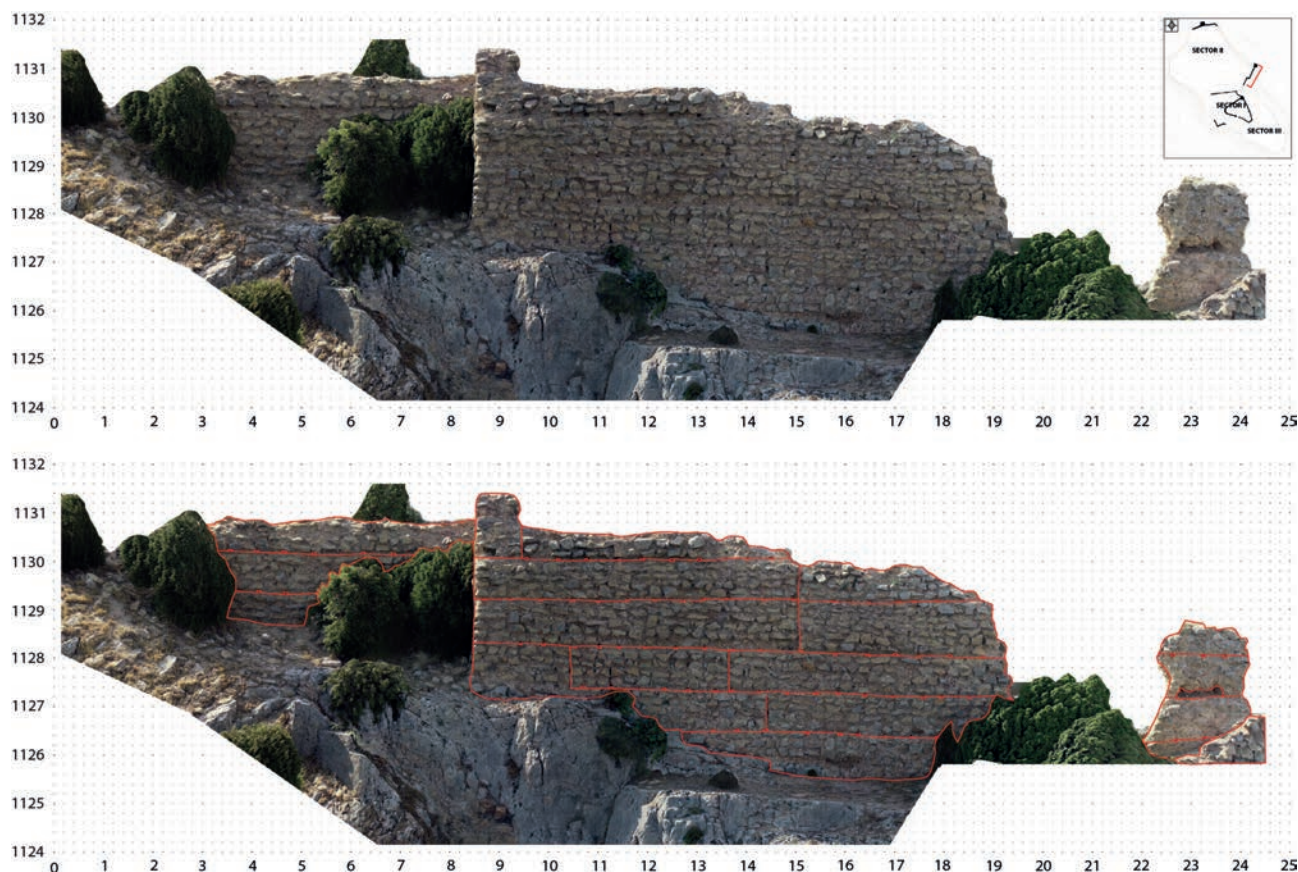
Sector II. Alzado fotogramétrico del segmento de muralla suroriental al que se adosa la Torre II.
